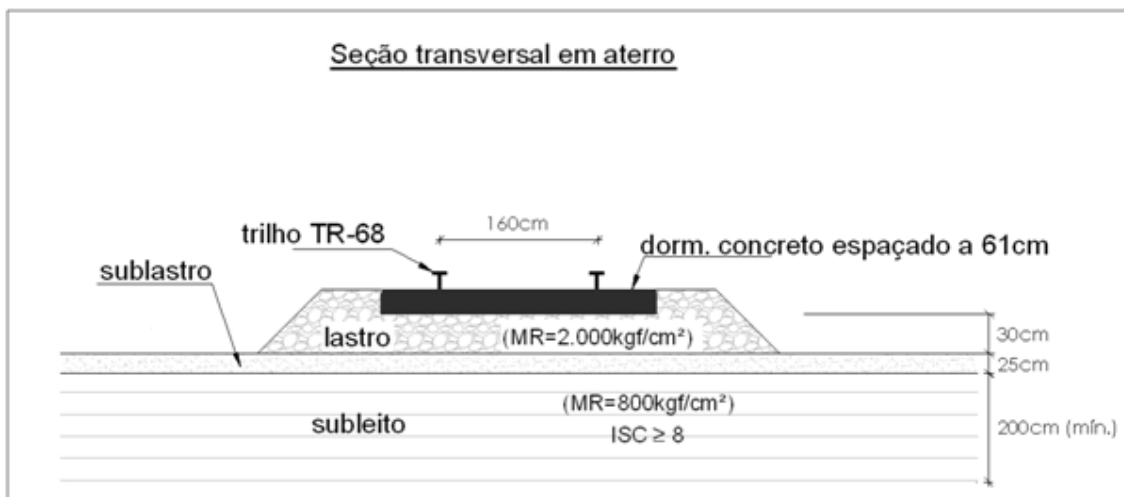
Seção transversal em aterro do pavimento ferroviário da duplicação da EFC no trecho 30-31 (SOUTO, 2010).
